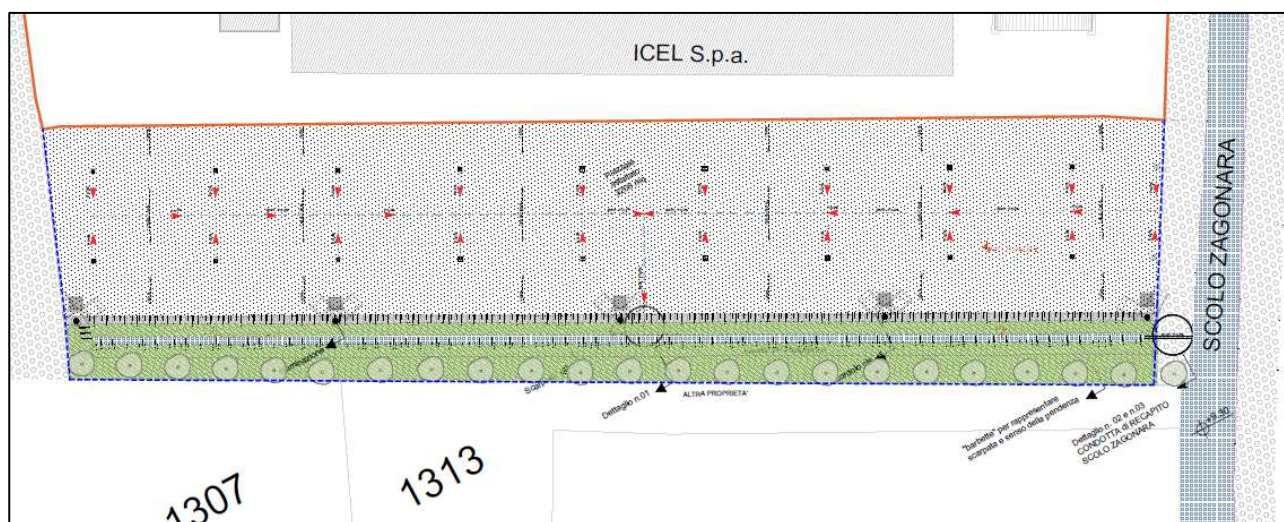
Stralcio tratto dalla Planimetria C23182-ARC-20250624-Base-AR_03.pdf
